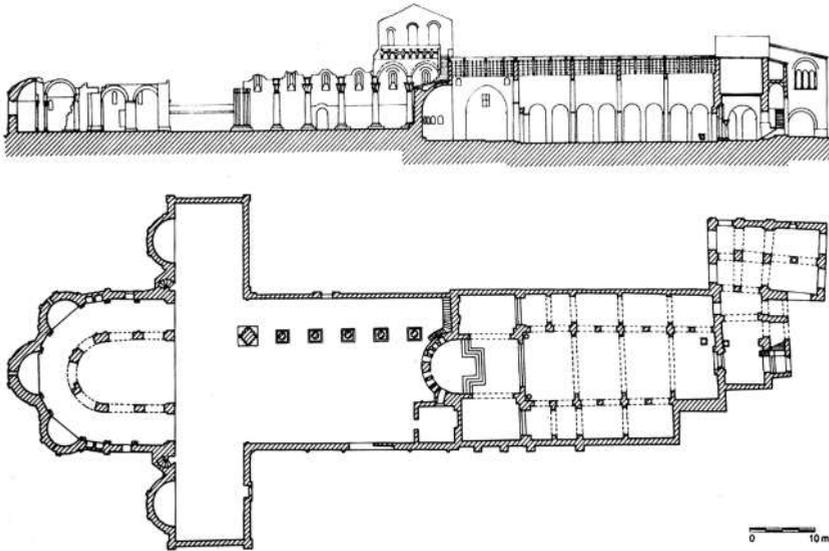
Pianta e sezione dell'abbaziale della SS. Trinità di Venosa
